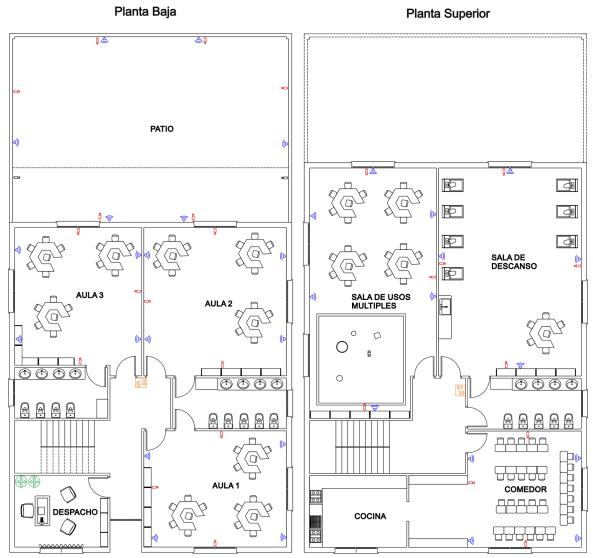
Plano de Centro Infantil ficticio con la instalación de Locaviewer
